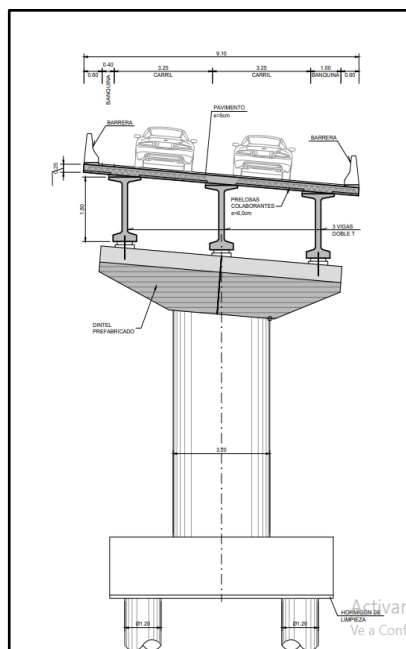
Sección tipo – Estructura PK 30+449 al PK 30+750
